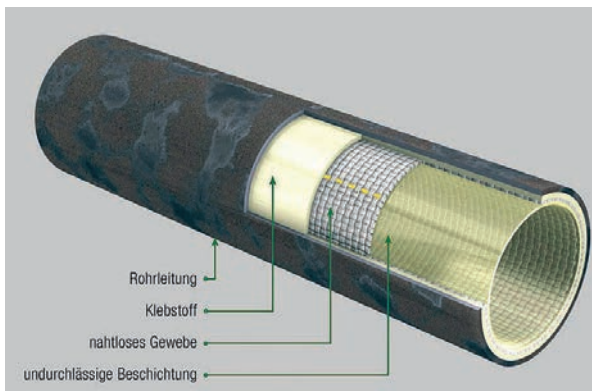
Gewebeschlauch in einem Altrrohr Verbundsystem bestehend aus mit der Rohrwandung vollflächig und hinterwanddicht verklebtem Gewebeschlauch
